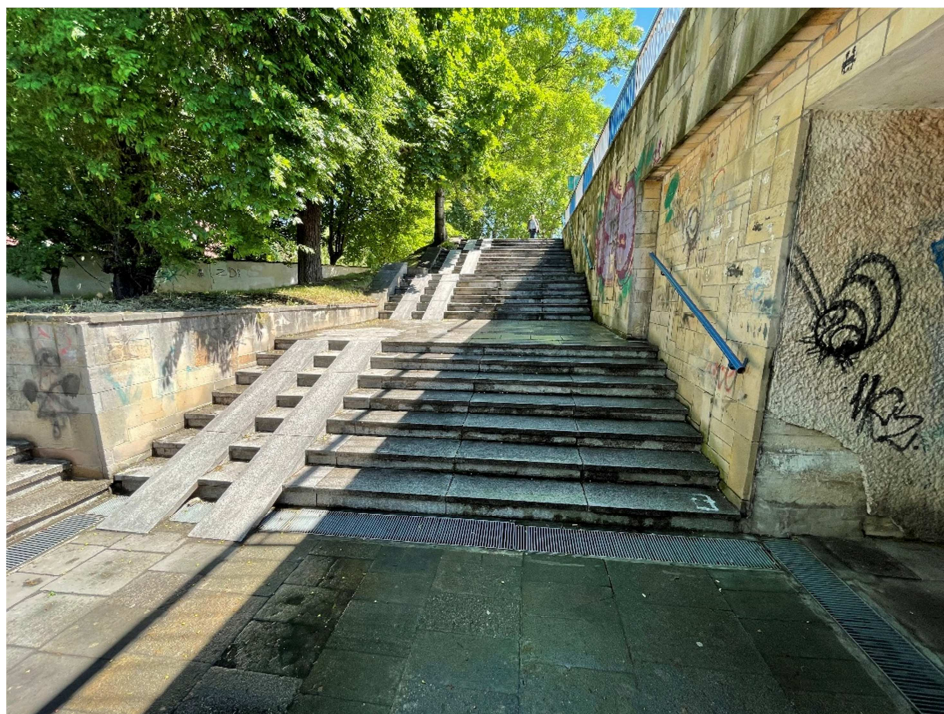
Widok posadzki przejścia podziemnego, Płyty betonowe, które wg wytycznych Zamawiającego należy przeprojektować na posadzkę z płyt granitowych
